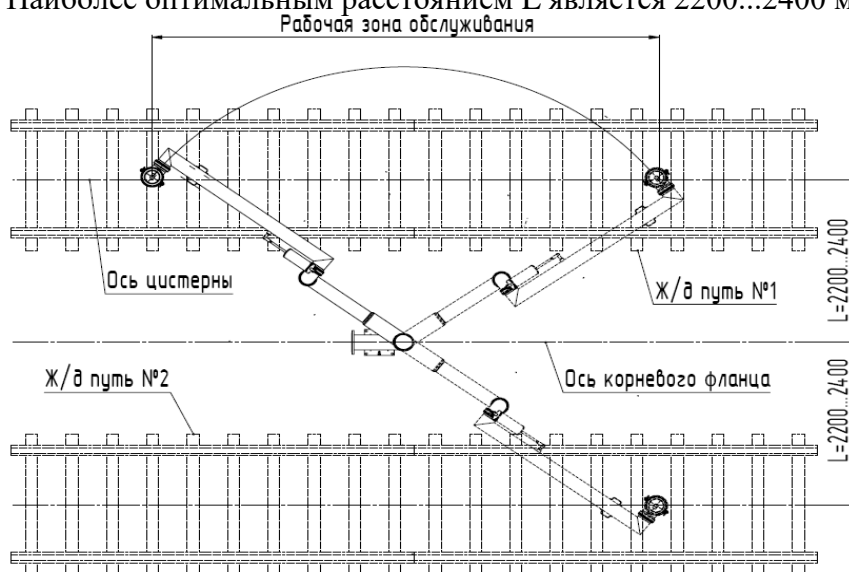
Установочные и габаритные размеры стояка ОСН-СНС-175-6
